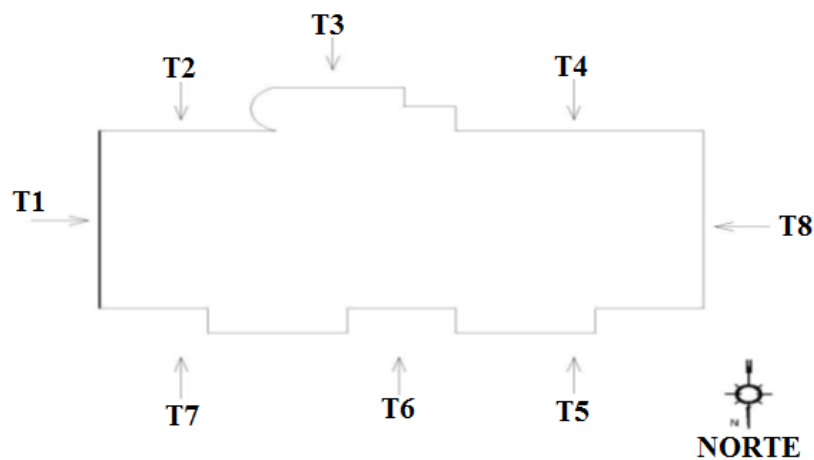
Croquis de la lámina del edificio identificando la fachada con la división de las áreas muestrales por trechos.
